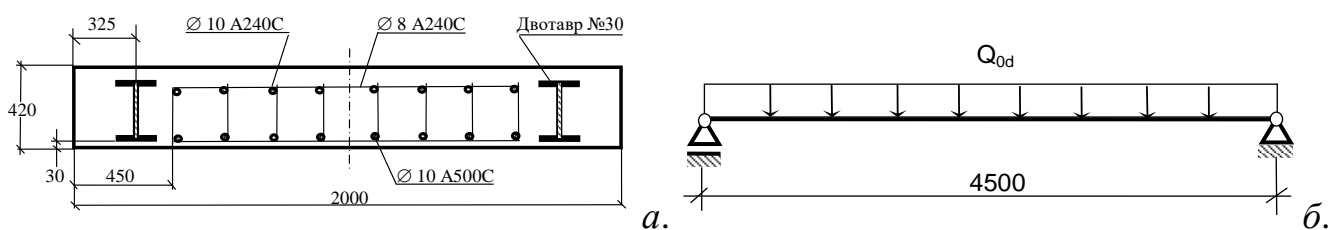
Схема армування перерізу сталезалізобетонної плити (а) та її розрахункова схема (б).
